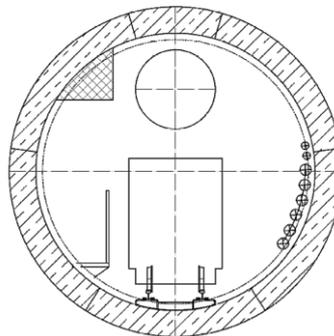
Sezione funzionale della galleria di derivazione in fase lavori
